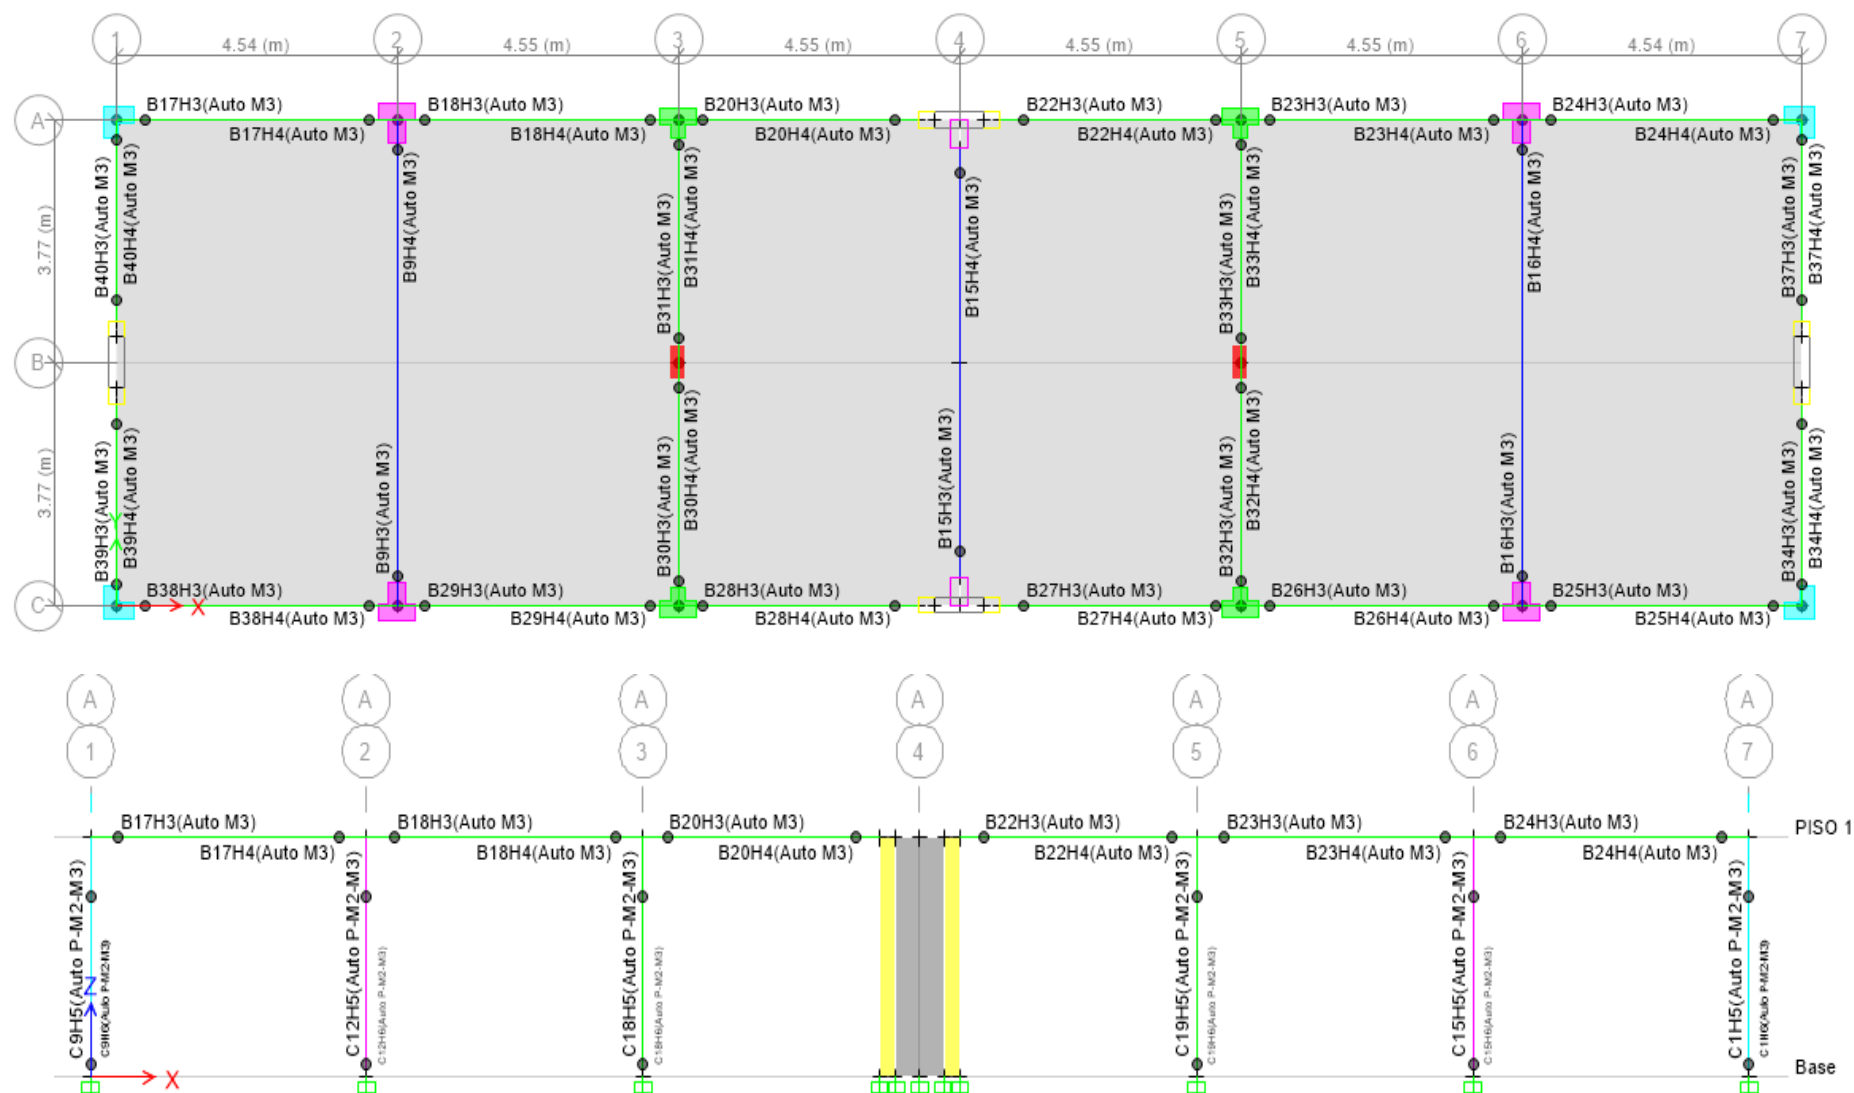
Rotulas Plásticas Vistas en Planta y Elevación en el Software Etabs V.16.2.1
